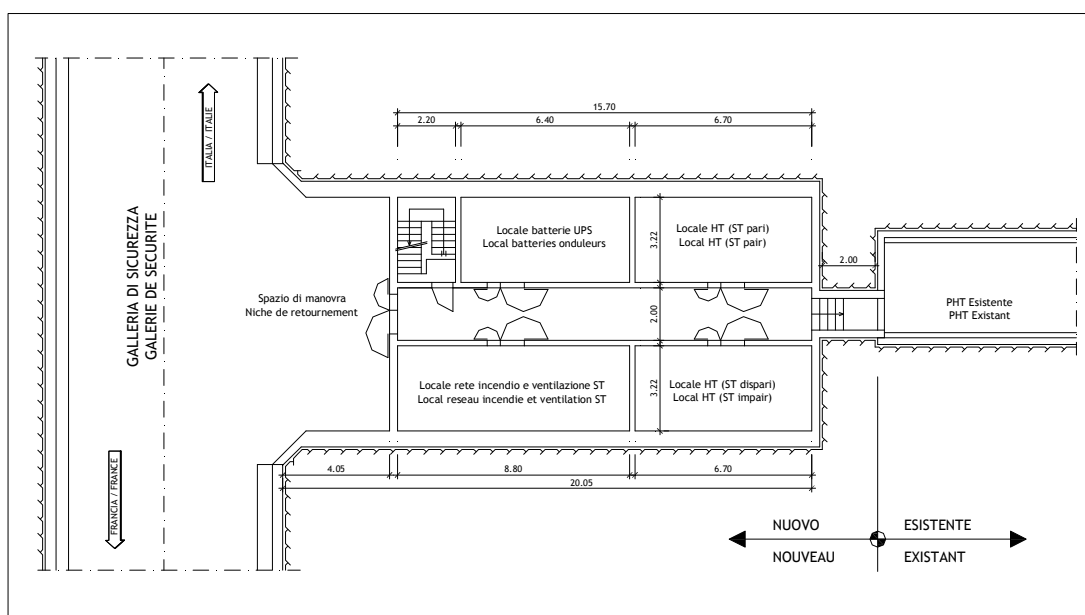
Stazione tecnica tipo - Pianta piano carreggiata
